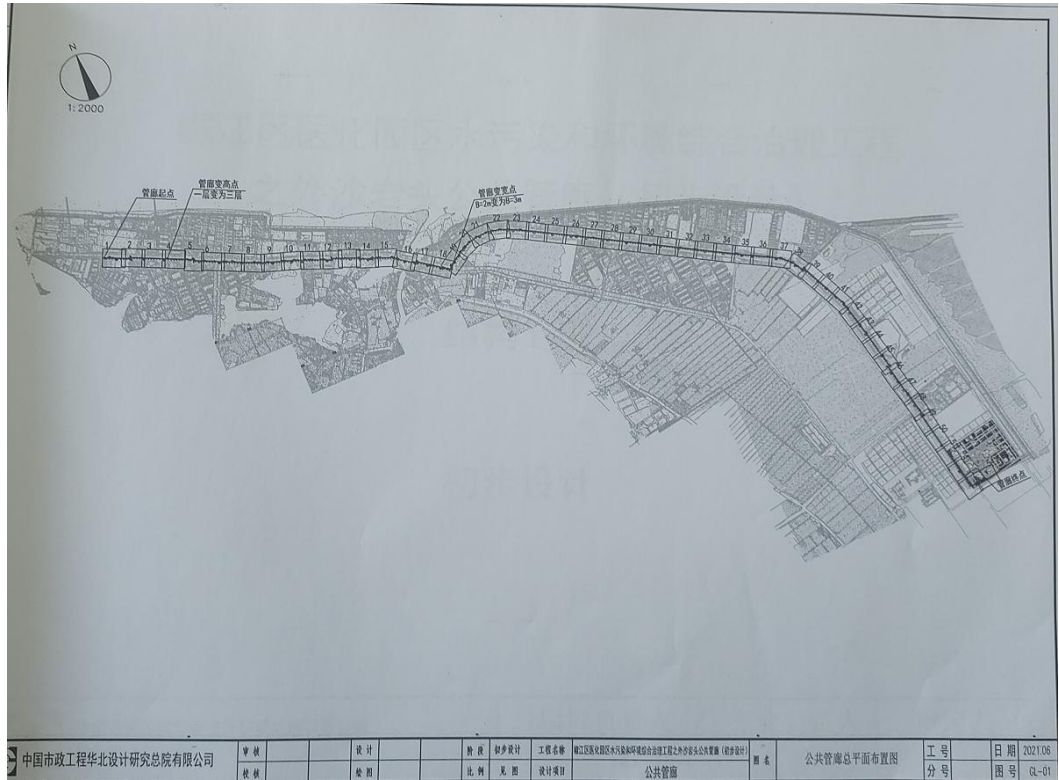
椒江医化工业污水处理厂公共管廊平面布置图
